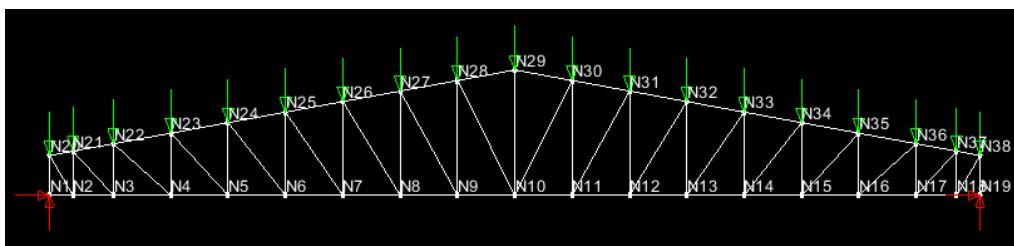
A Viga treliçada de cobertura sobre apoios fixos. Fonte: Autor.
